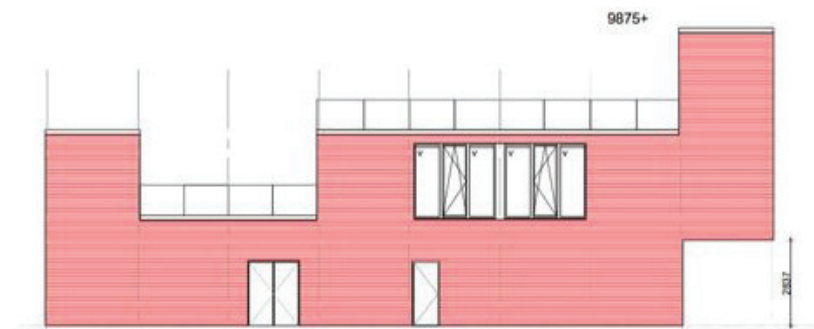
Prospetto (Villa Camera); Fonte: <http://xxarchitekten.nl/>;
